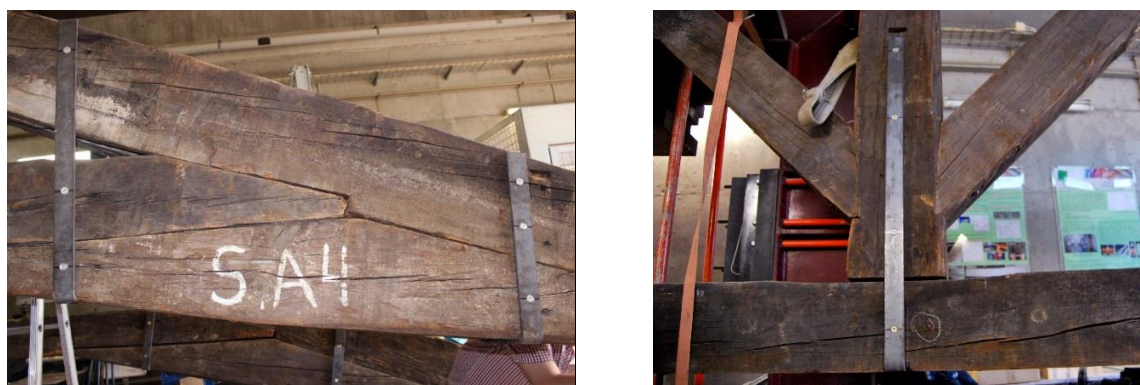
Exemplos de ligações por entalhes reforçadas com braçadeira
